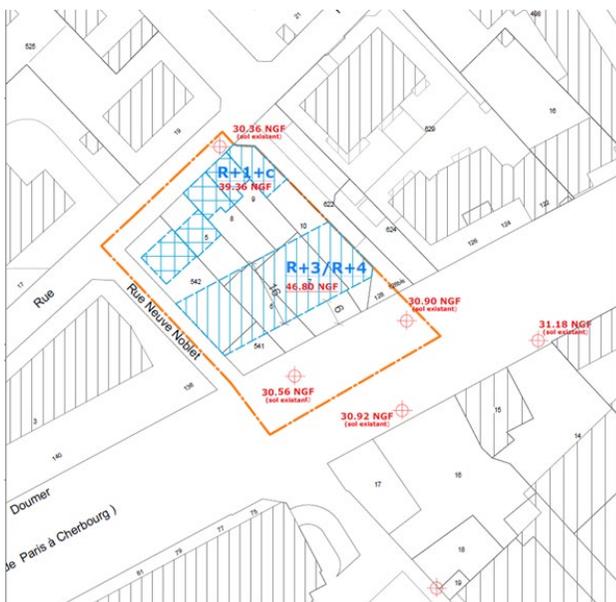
Dispositions en vigueur au sein du secteur USP14 (Jean-Jaurès)
